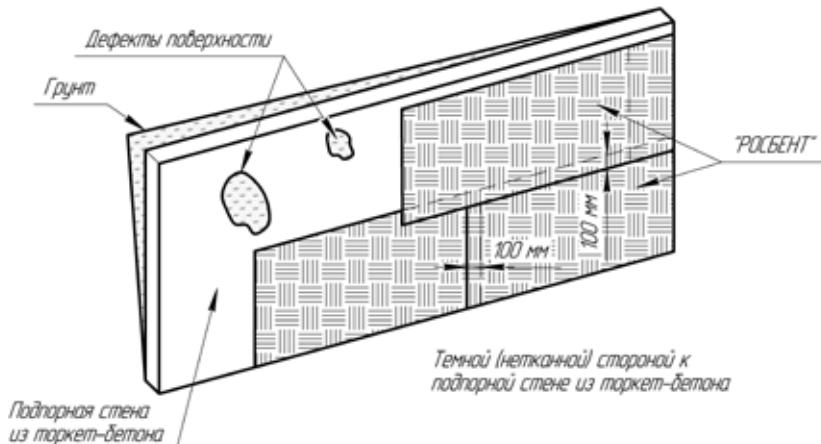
Укладка «Росбент» на вертикальную поверхность подпорной стены из торкетбетона
